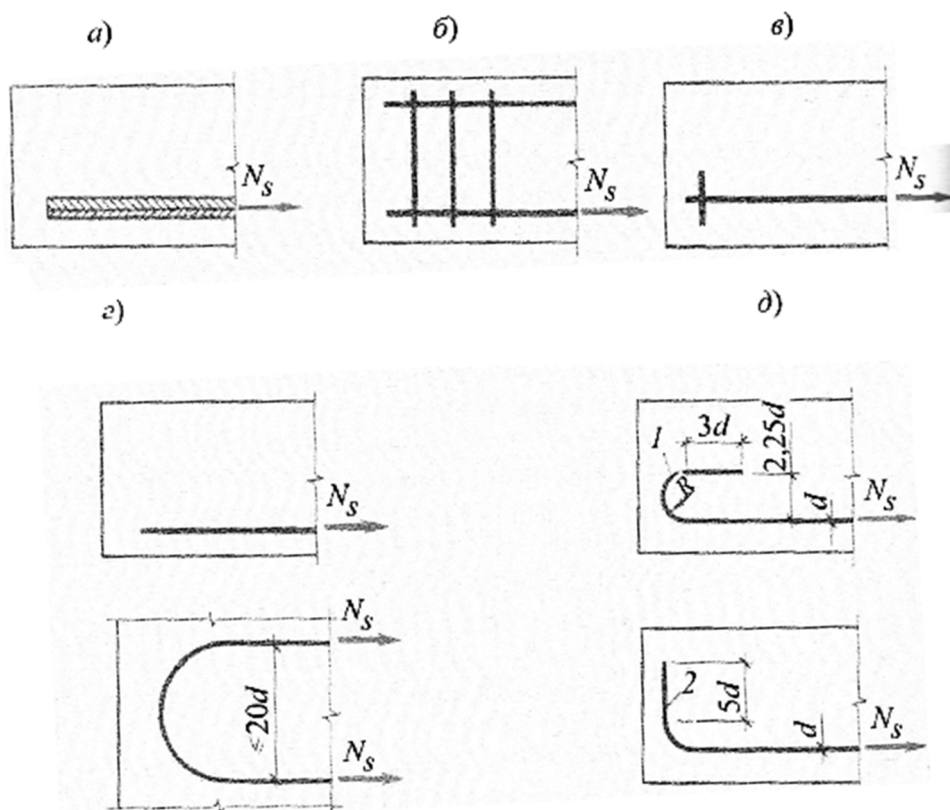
Способы анкерования ненапрягаемой арматуры:
